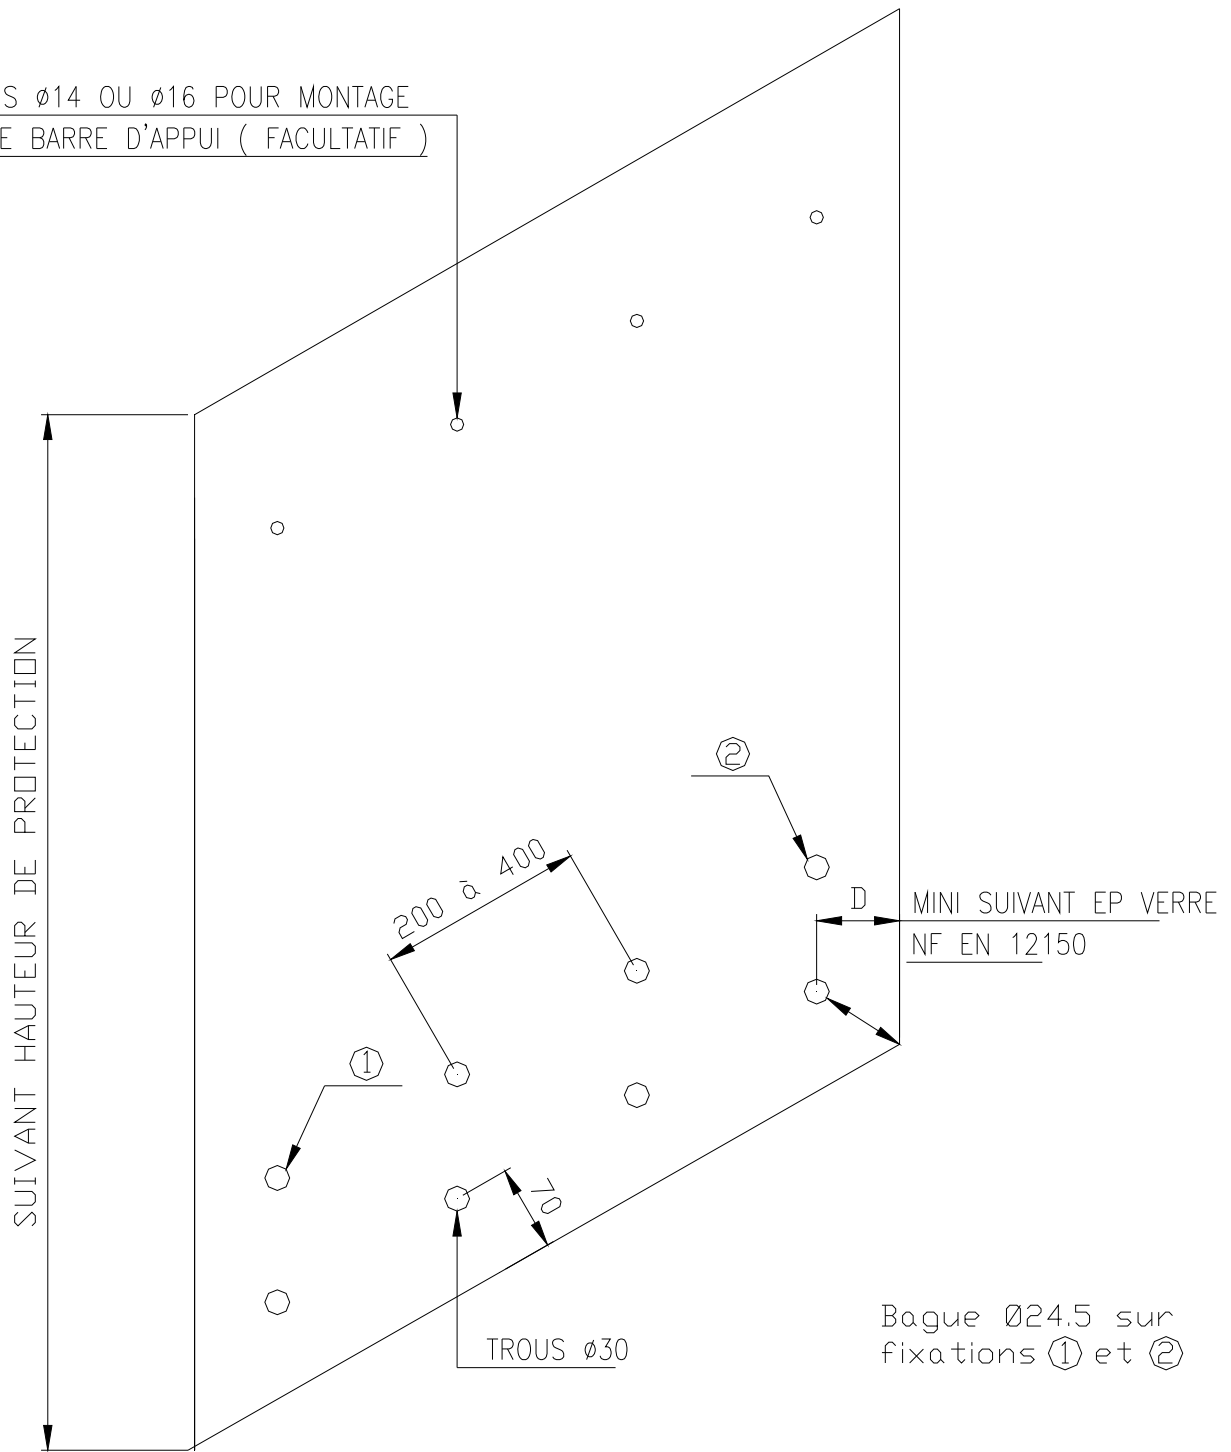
Vitrage plan Structaflex pour Balustrade P pour rampant
